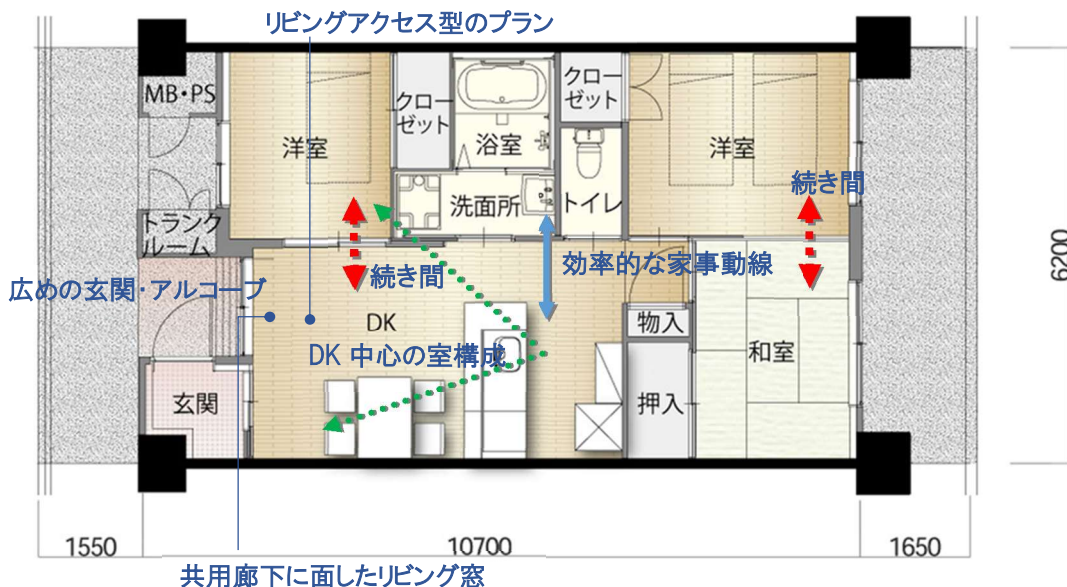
3DK_PLAN 約60㎡（3人以上世帯用）
